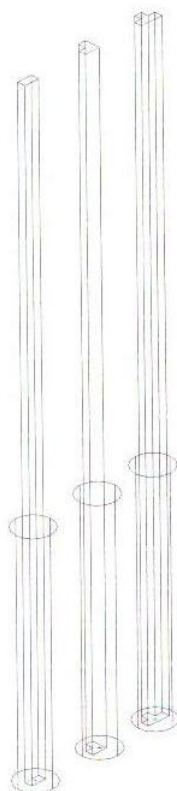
Detalhe do encaixe dos pilares nas estacas
